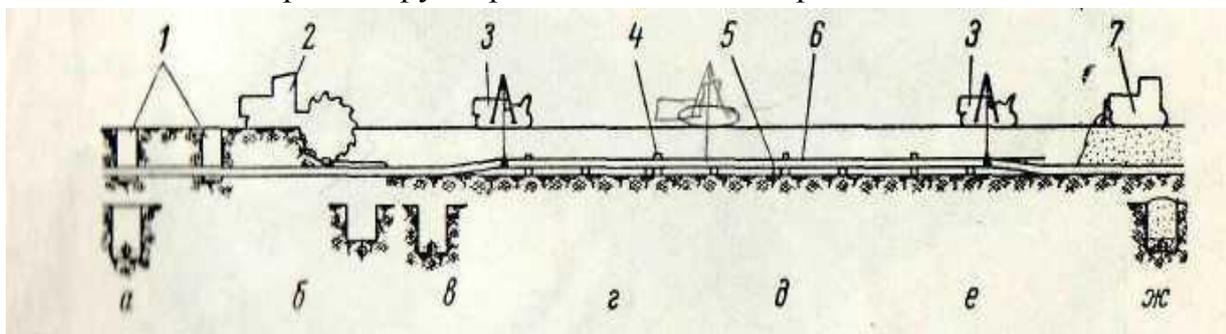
Схема производства работ при ремонте трубопровода с подъемом его на лежки
